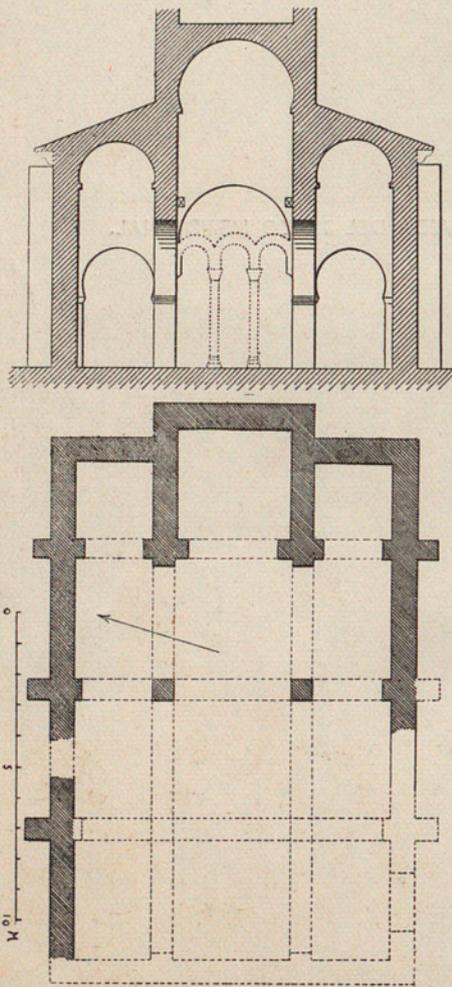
CORTE Y PLANTA DE SANTA MARÍA DE BAMBA.
